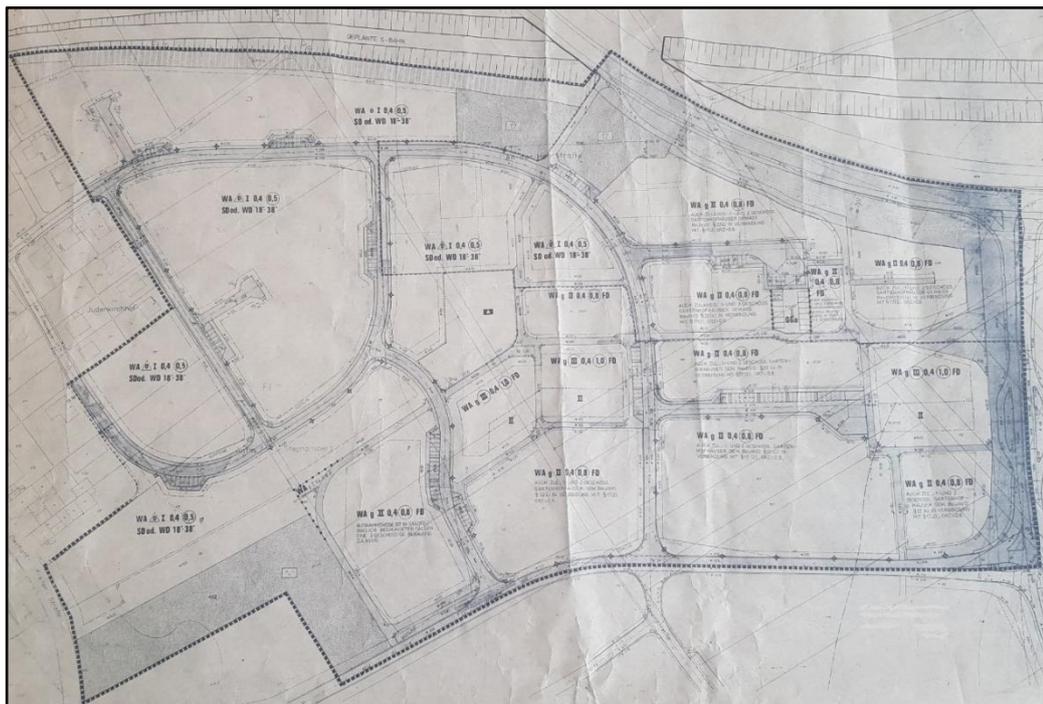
Bebauungsplan Nr. 49, 1. Änderung (Auszug) | ohne Maßstab
